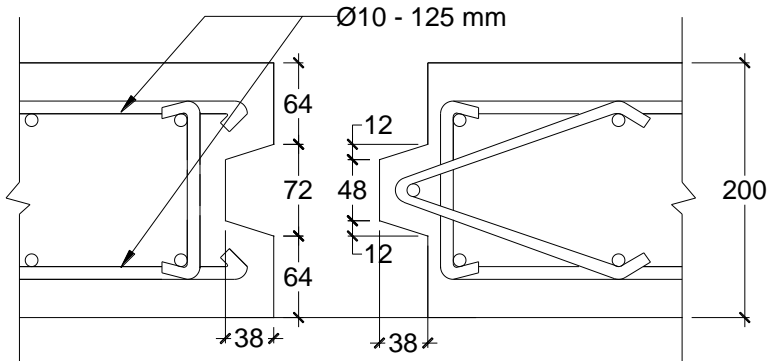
Detail Pemasangan Tie bars Arah Memanjang Pada Panel Ukuran 3,5 x 9,5 m
